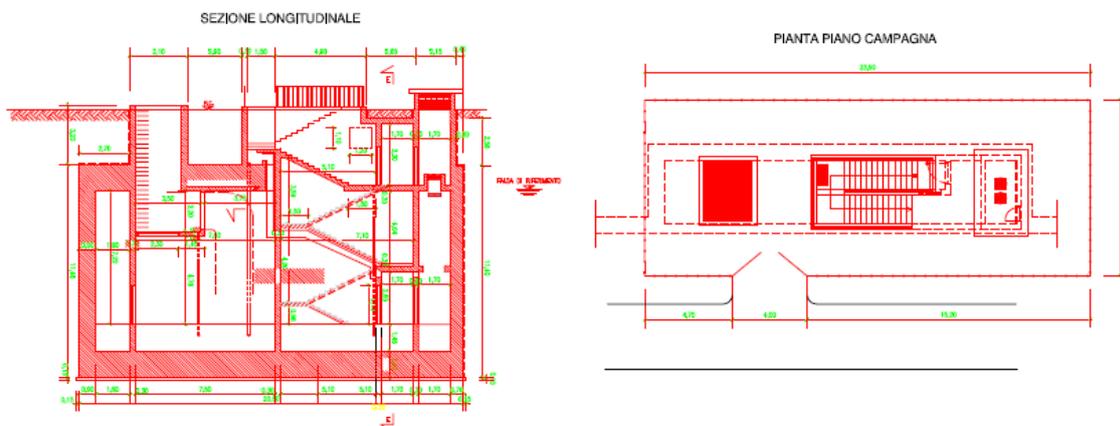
WBS GA1M – Pianta e sezione longitudinale delle uscite di sicurezza
